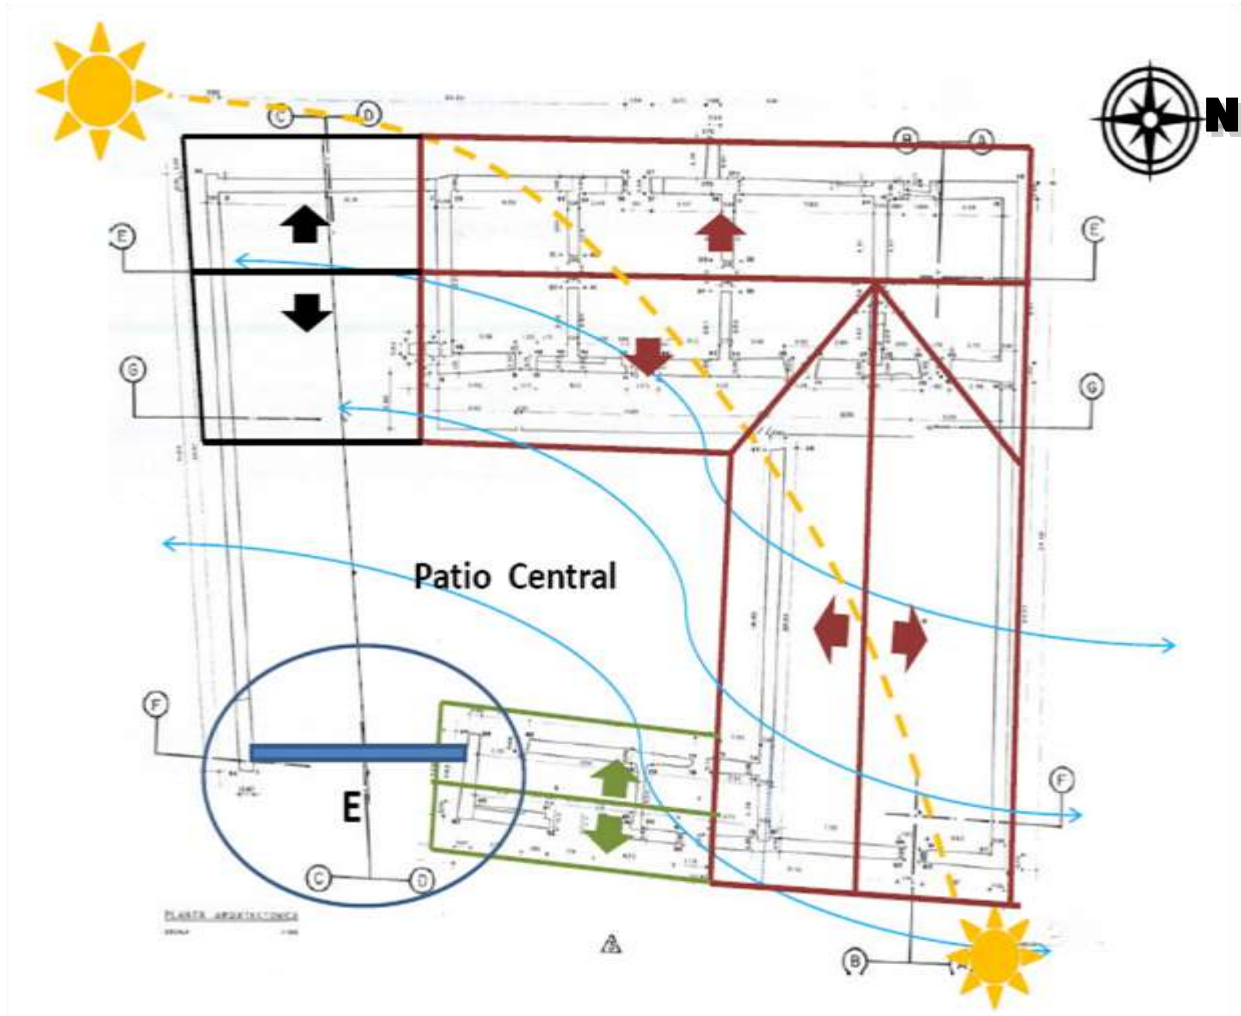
Propuesta del Sistema de Cubiertas con base en la evidencia arqueológica del sistema estructural y constructivo; análisis del sistema de ventilación y asoleamiento. M. Pérez
